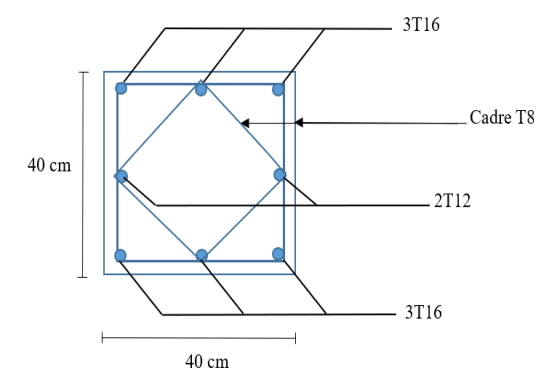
Ferrailage des poteaux.V.4 Ferrailage de voiles :V.4.1 Introduction :
